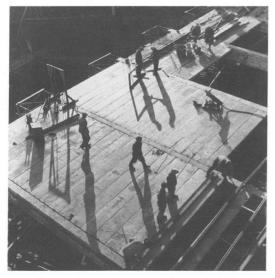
Construcción de la estructura prefabricada del Edificio Porthania, 1950-1957 (Johansson, Lahti y Paatero 2010)
